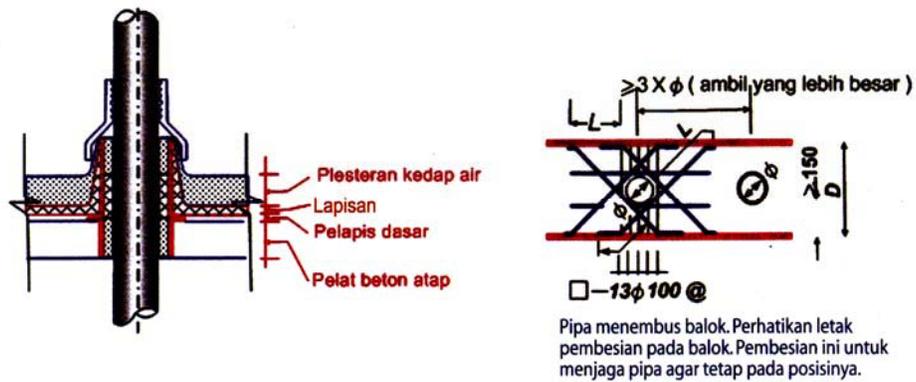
, Plesteran Kedap Air Dengan Penutup Bata
